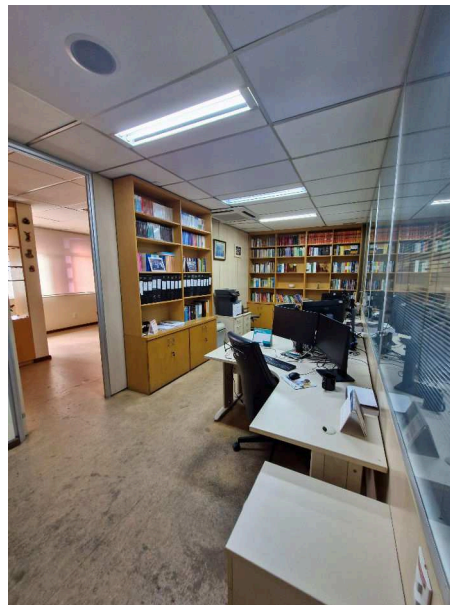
estrutura atual de forro com modulação de 1250 mm x 625 mm, fibra mineral e estrutura de fixação em perfil de alumínio a ser removido.
